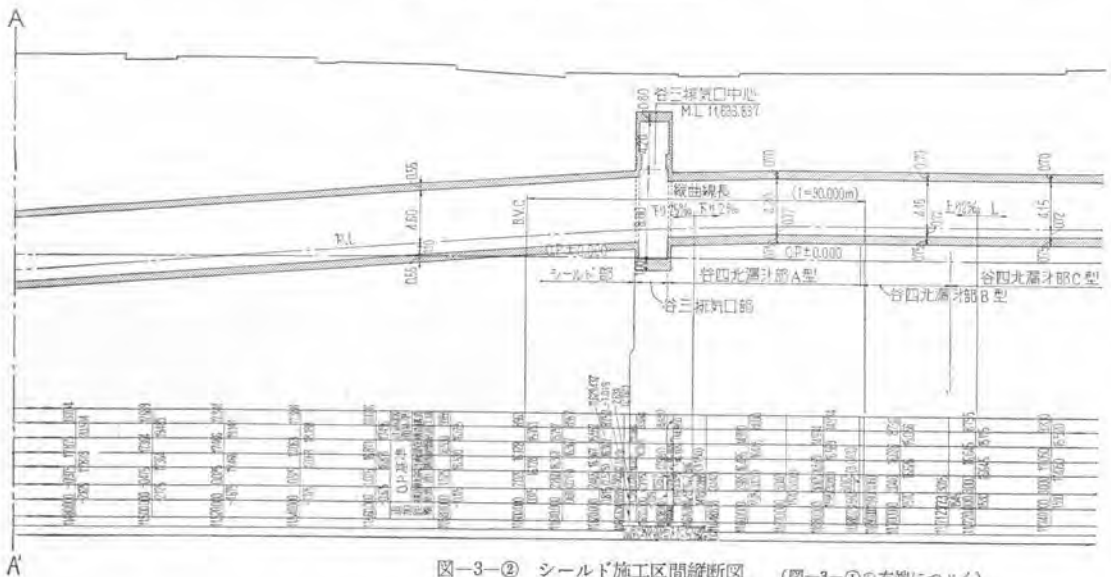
② シールド施工区間縦断面図 (図-3-①の右端につづく)
